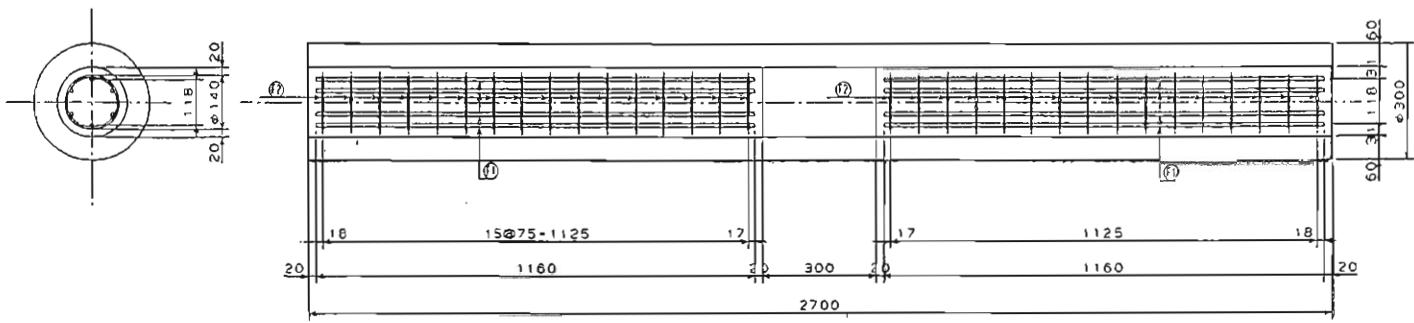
中詰めコンクリート部の配筋図（ケース3）
